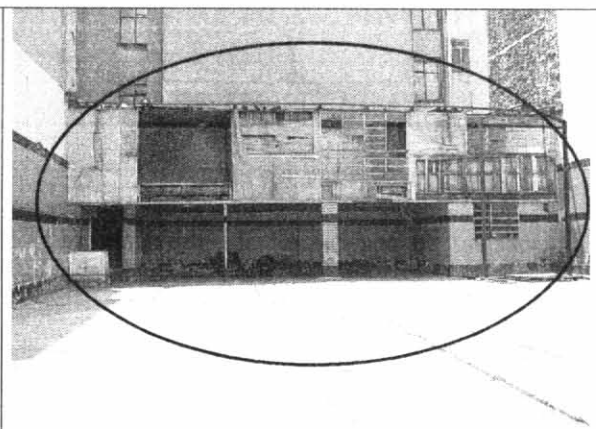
Construcción de dos (2) pisos ubicada hacia el costado norte del predio.
